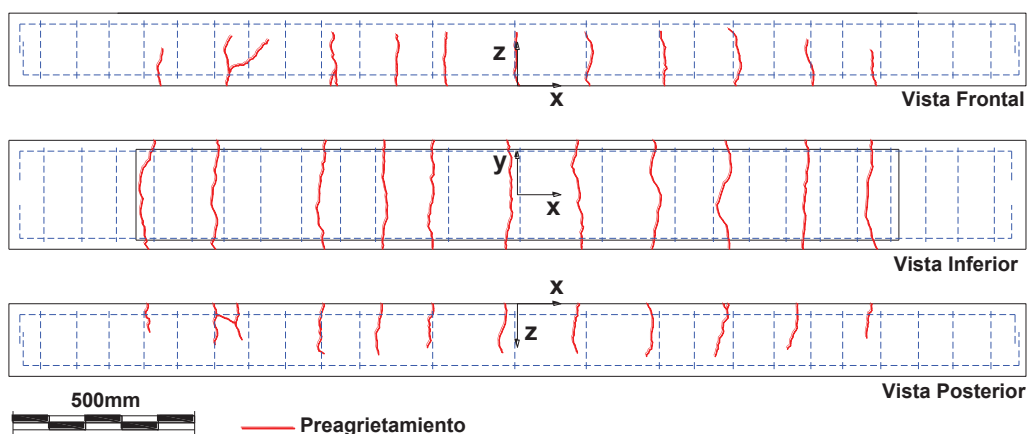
Esquema del patrón de agrietamiento de viga 1B.
